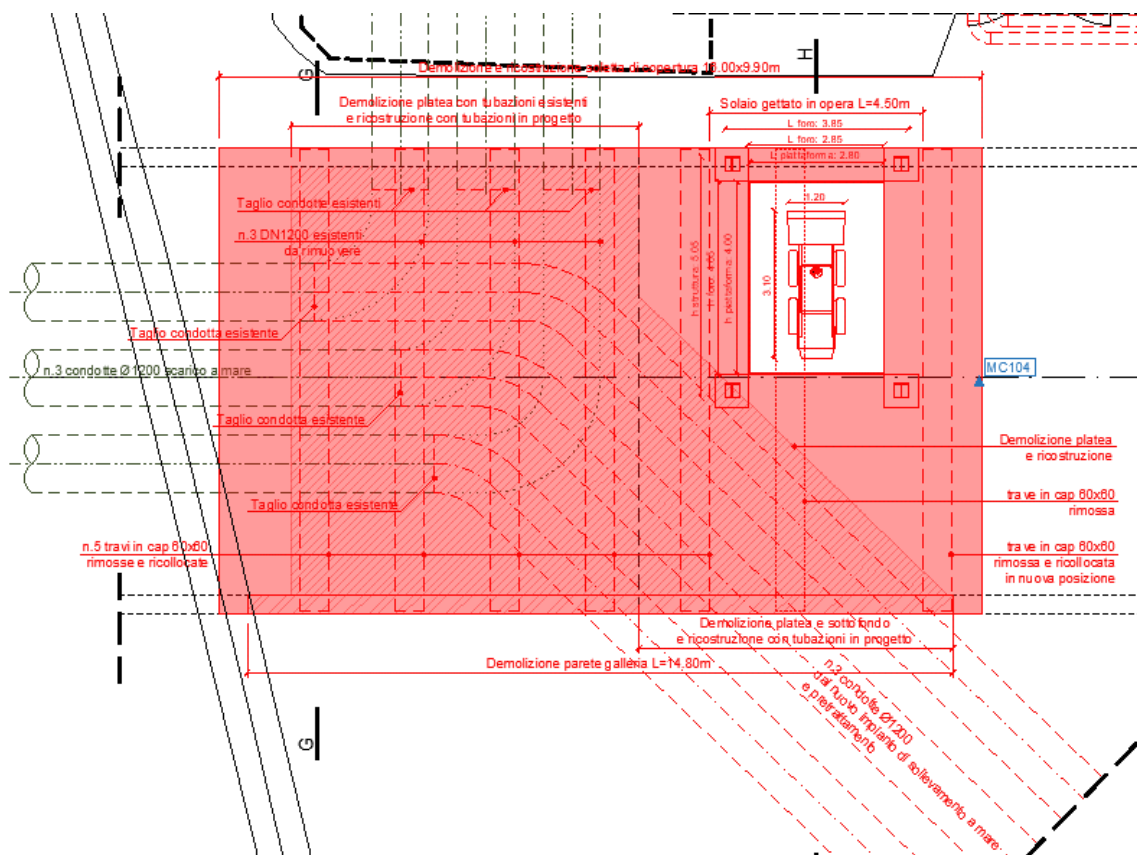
Interventi sulla galleria di Seiano: Pianta
